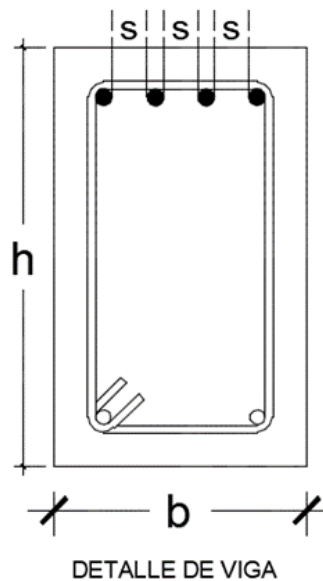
81 Separación mínima de varillas individuales en una viga.
